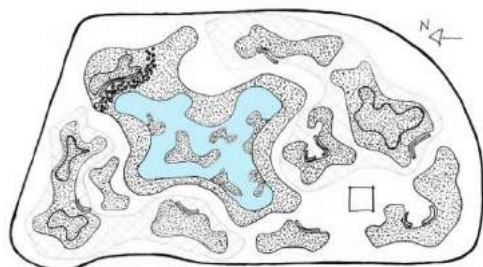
Planta baixa esquemática da Praça Senador Salgado Filho. Fonte: Desenho da Autora
